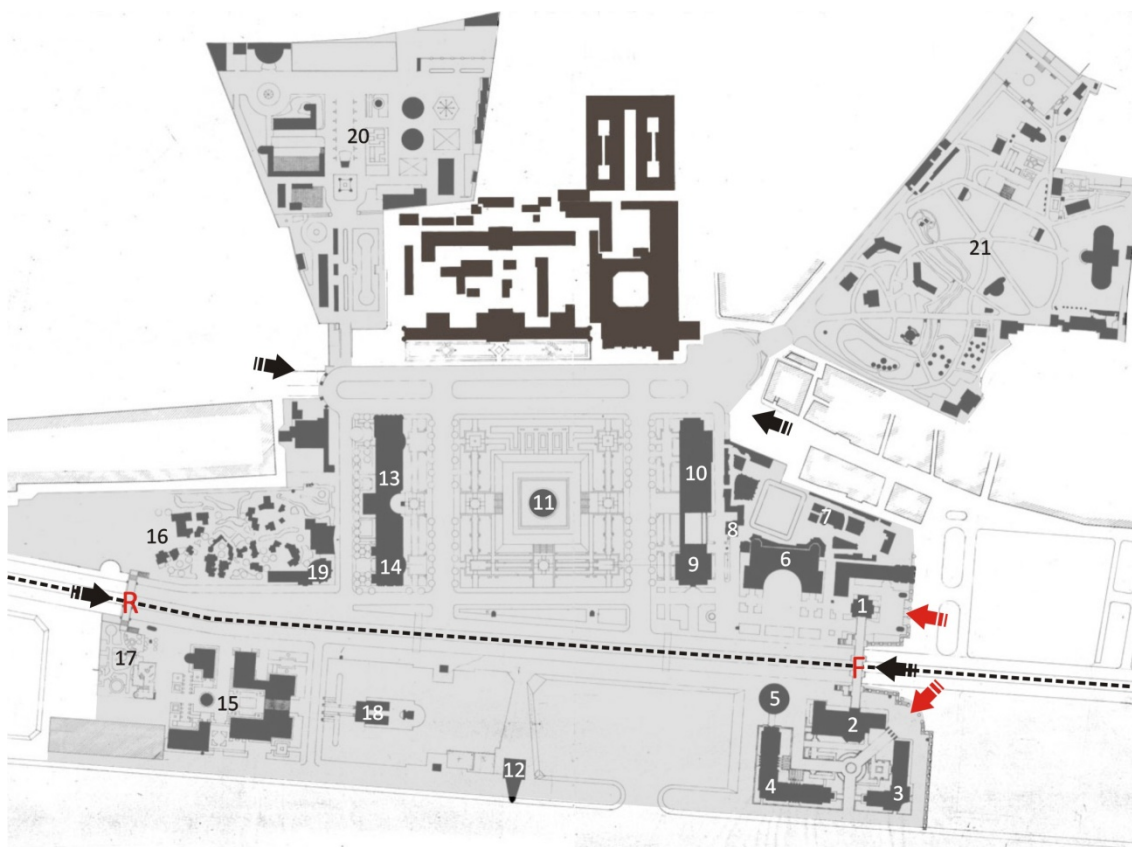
| PLANTA GERAL DA EXPOSIÇÃO.
